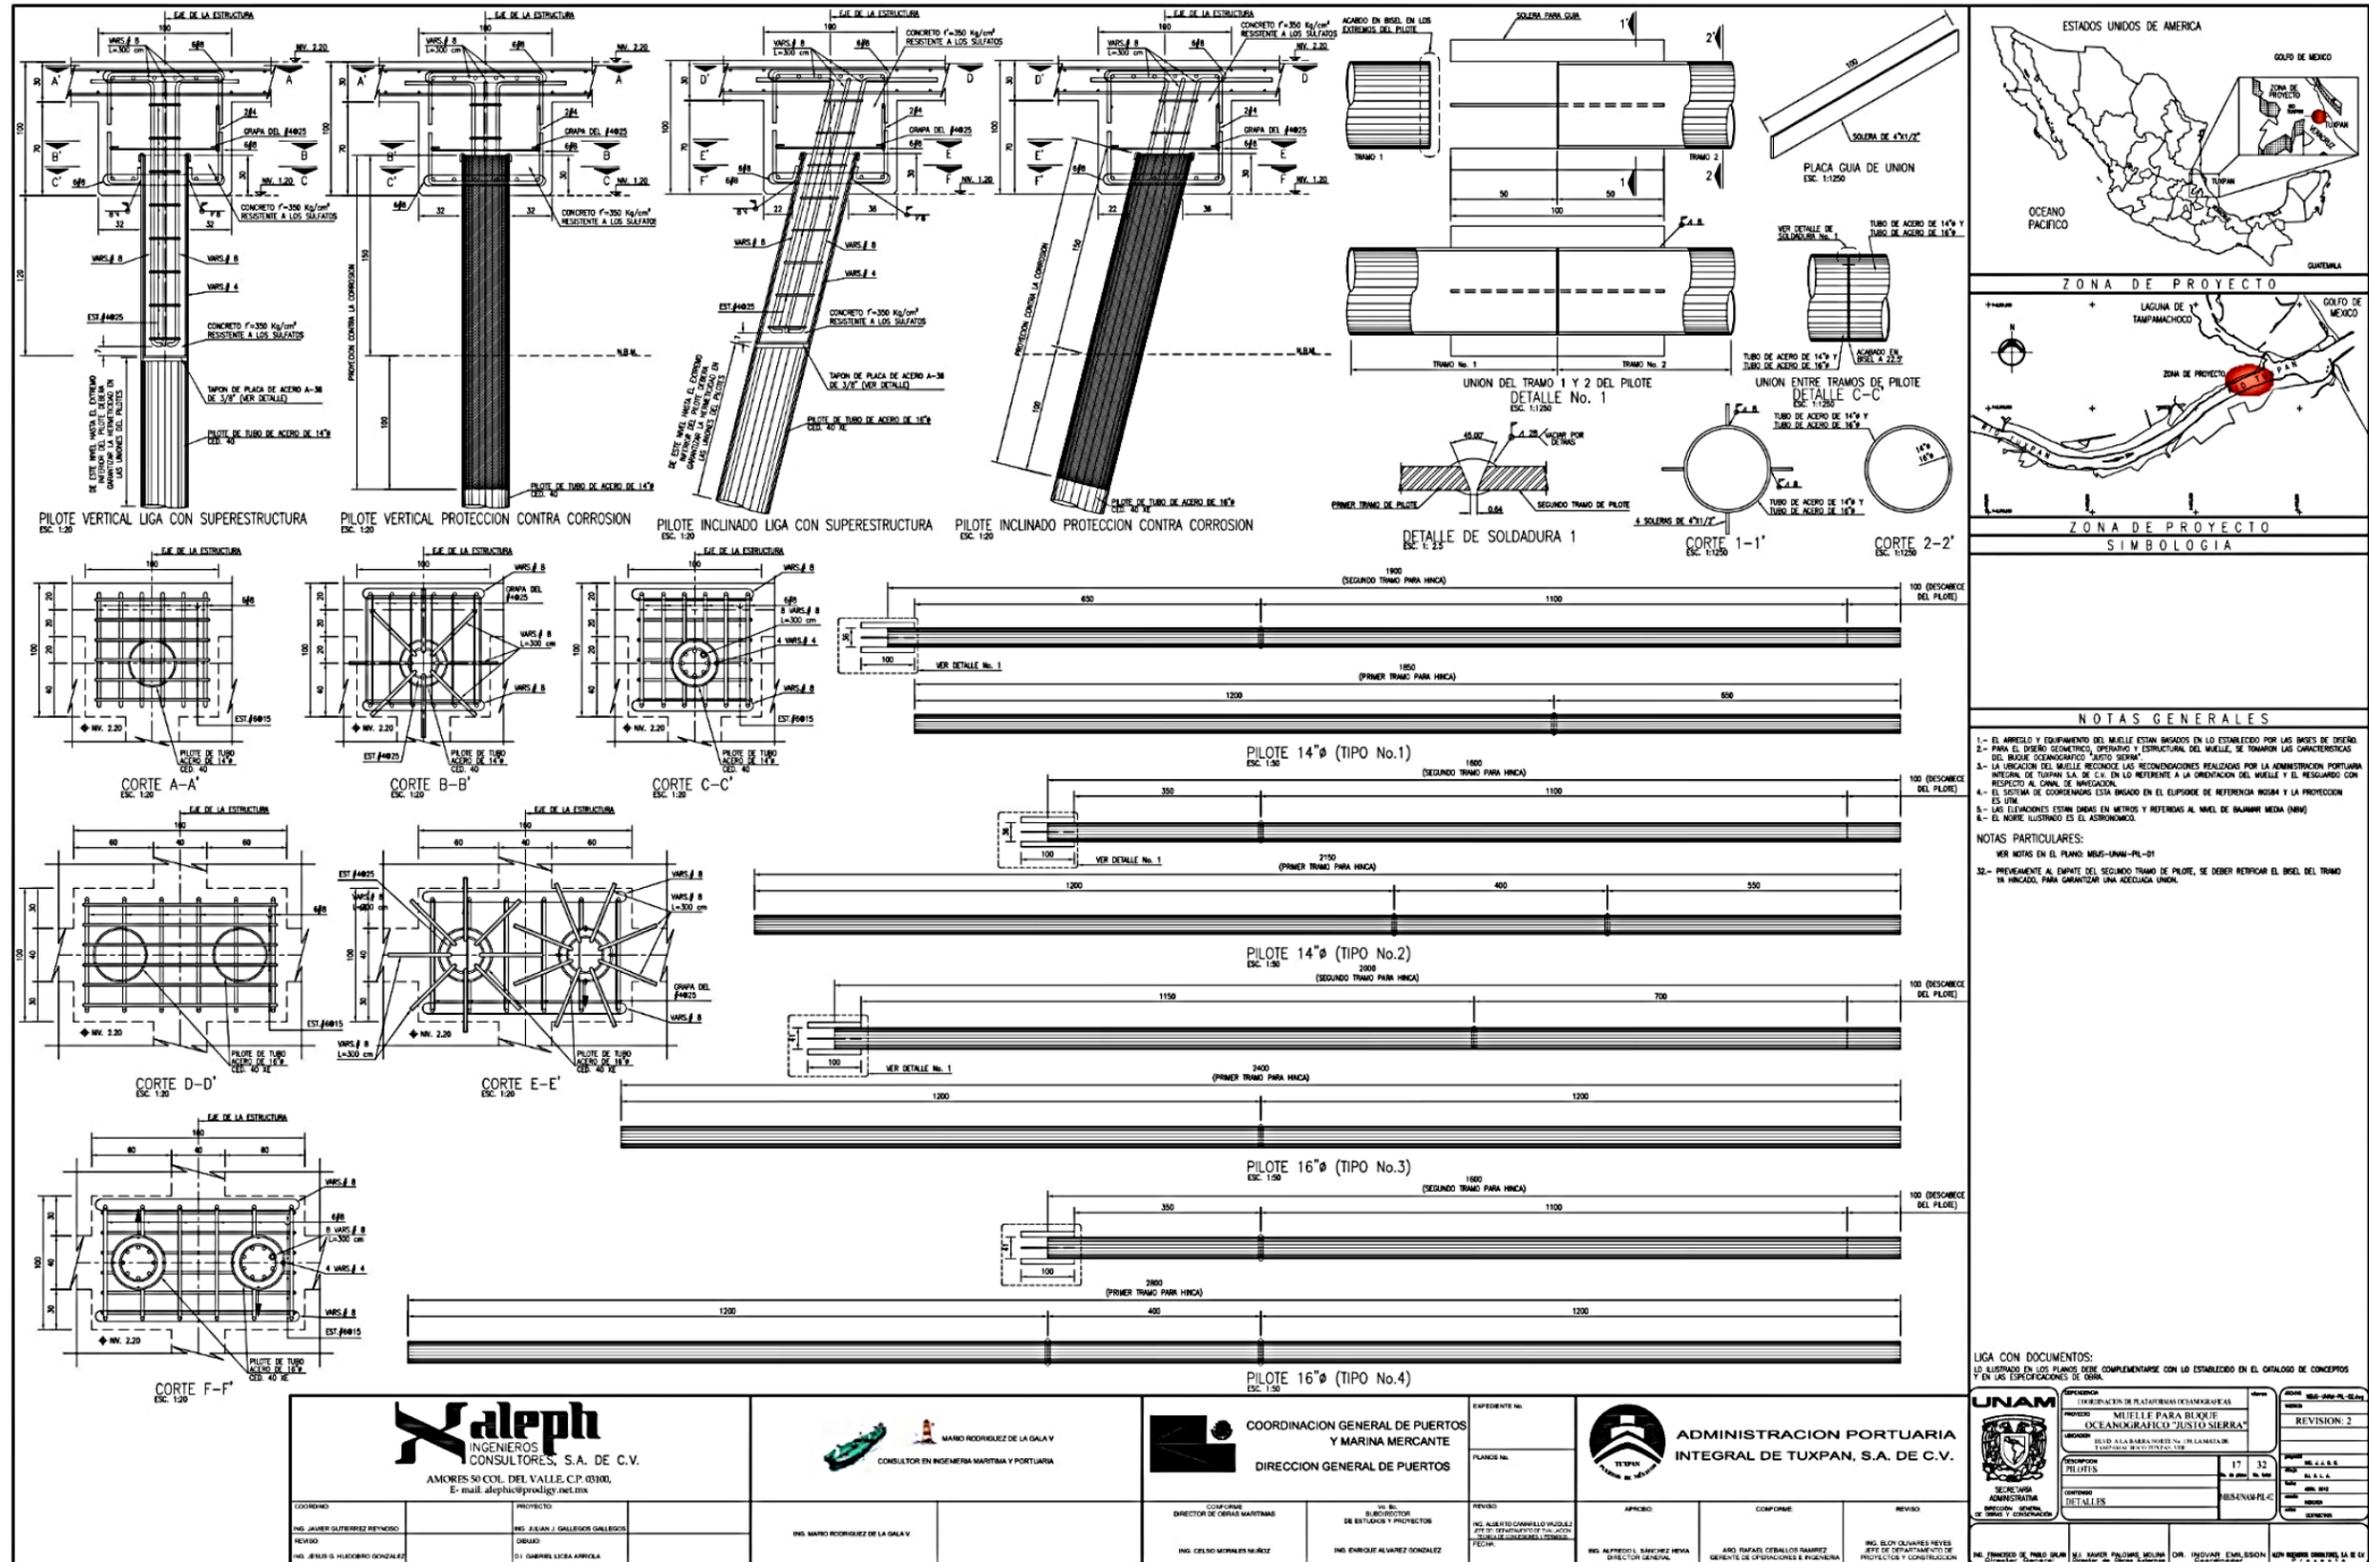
Plano de Habilitado de Pilotes verticales (PV) e inclinados (PI).
